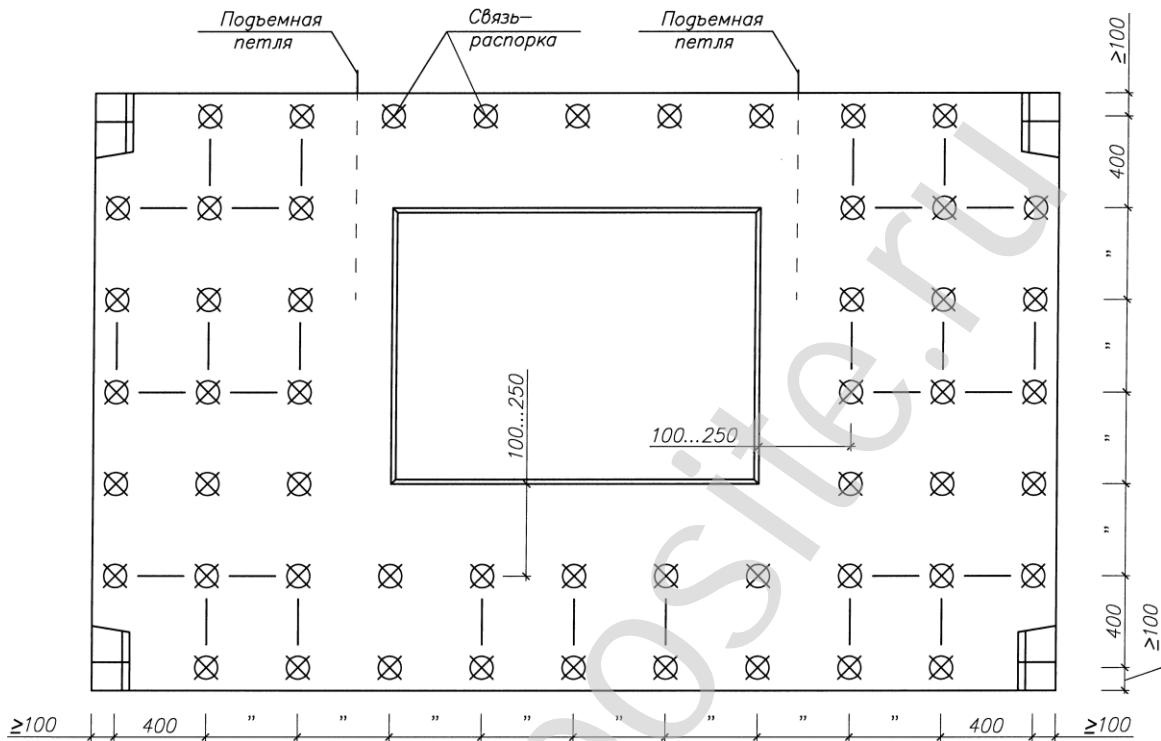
Схема расстановки связей в трехслойной железобетонной панели
